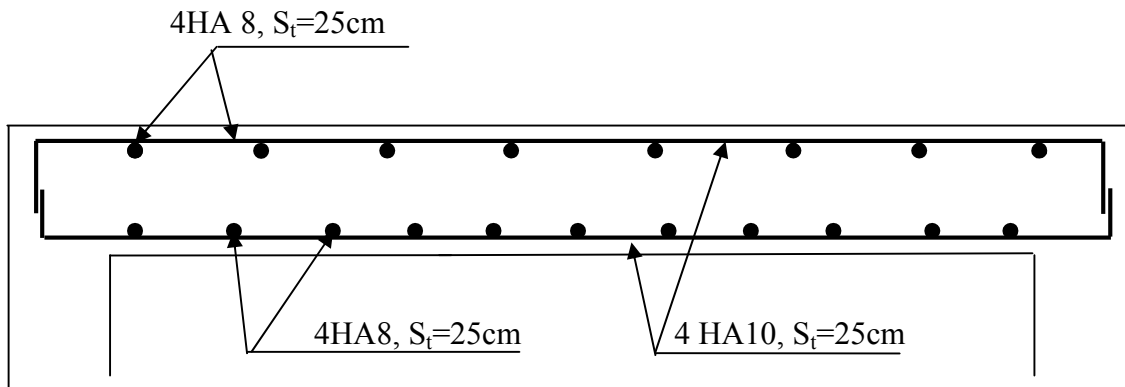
Plan de ferrailage de la salle machine suivant x-x.
